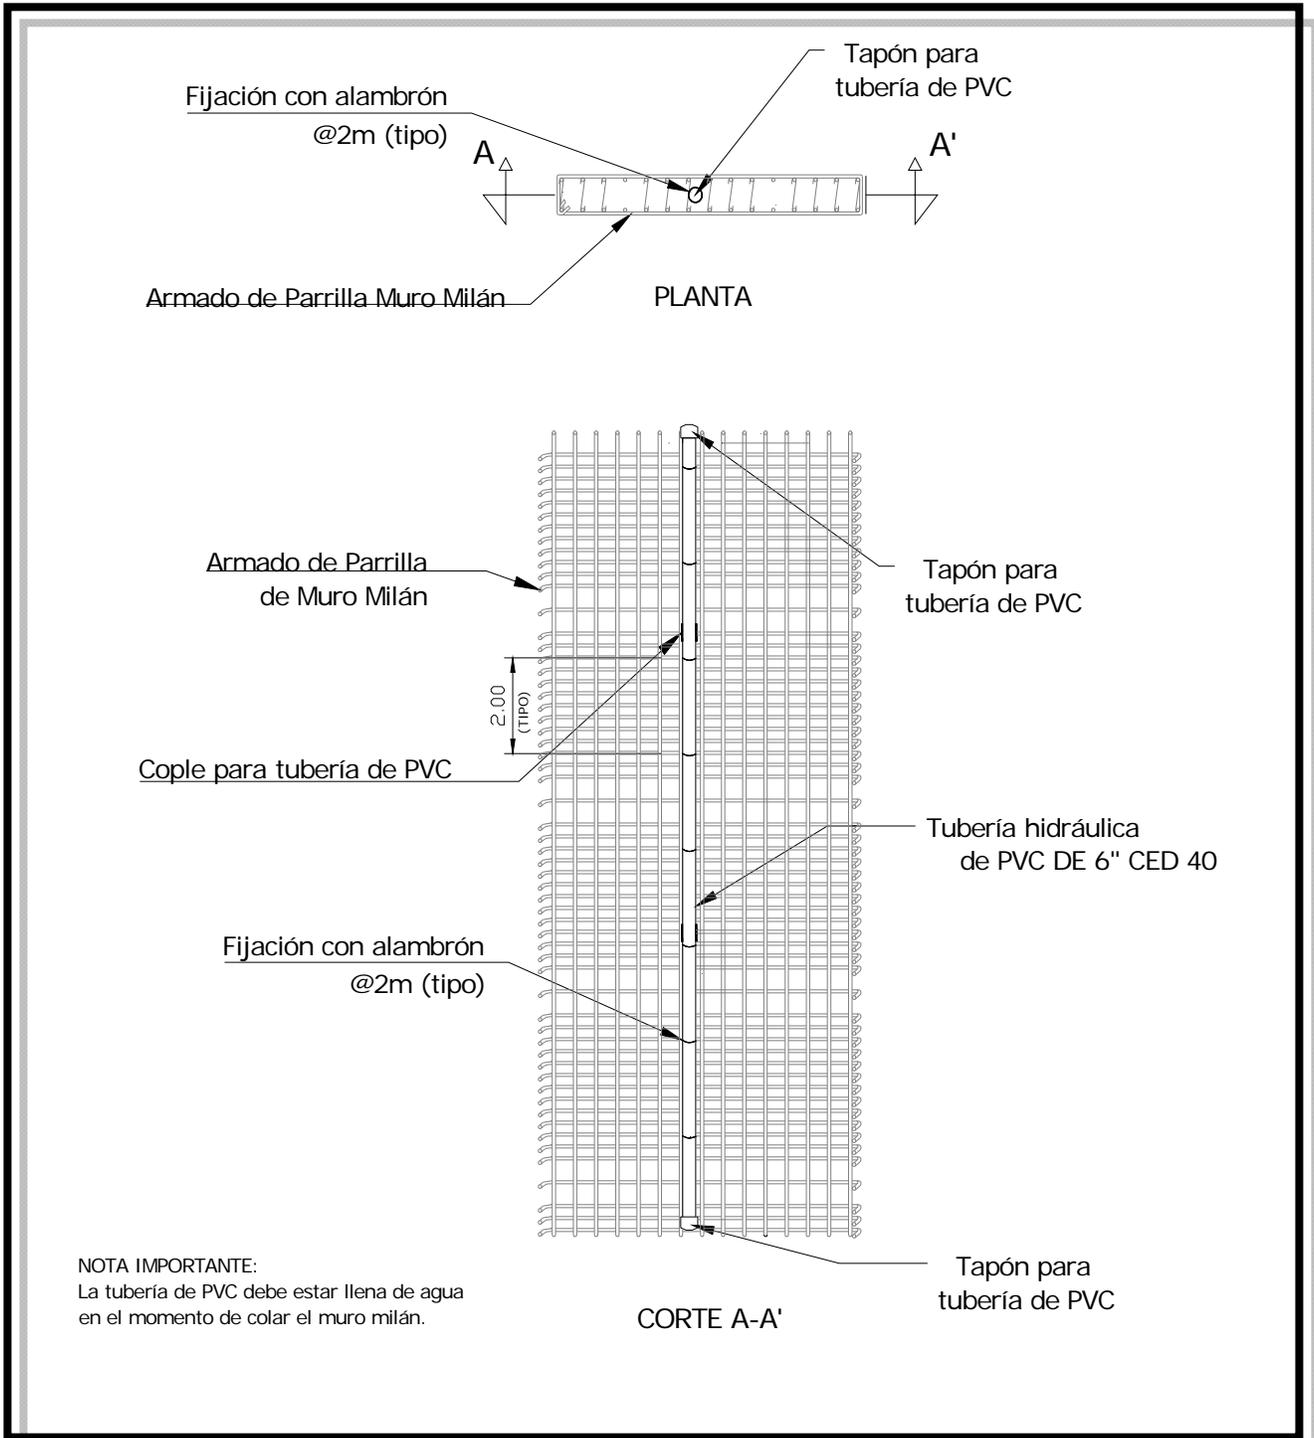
Instalación de inclinómetro en muro Milán
